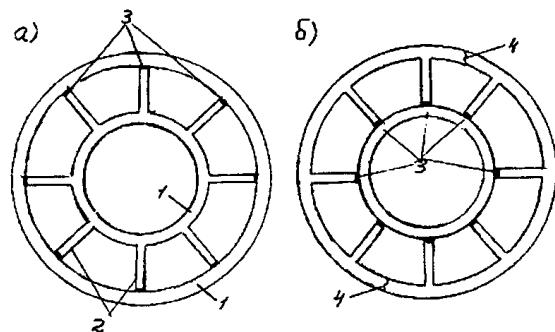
Схема деформации наружных стен здания кольцевой формы в плане (а — при повышении температуры наружного воздуха; б — при понижении температуры наружного воздуха):
